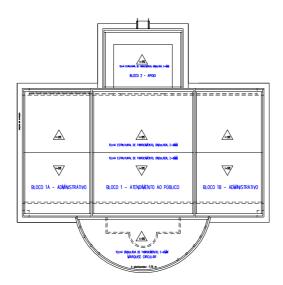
Correspondência entre planta de coberta e projeto estrutural
